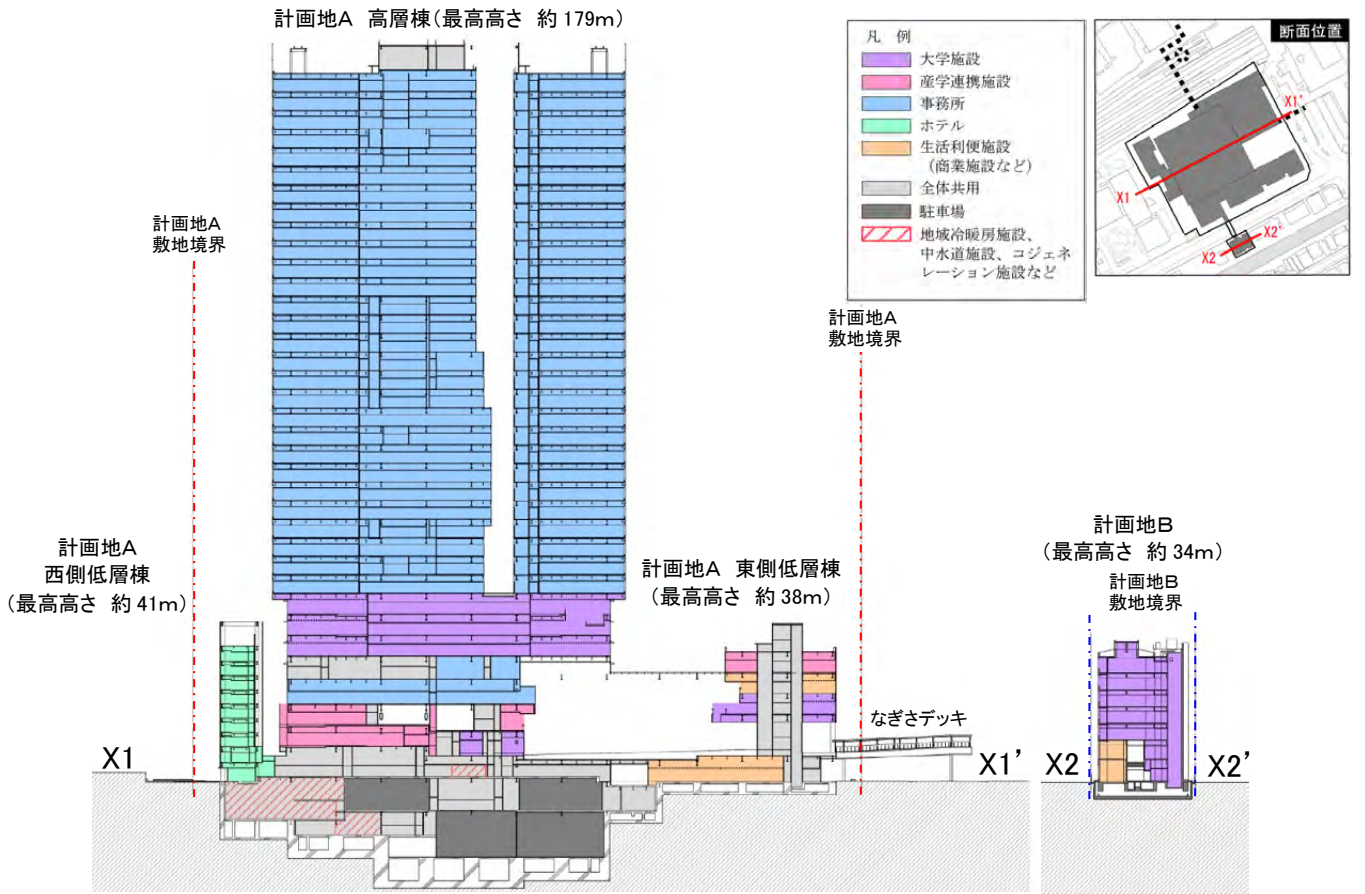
(1) 計画建築物断面図 (X1-X1'、X2-X2' 断面) (S = 1 : 1,800)
